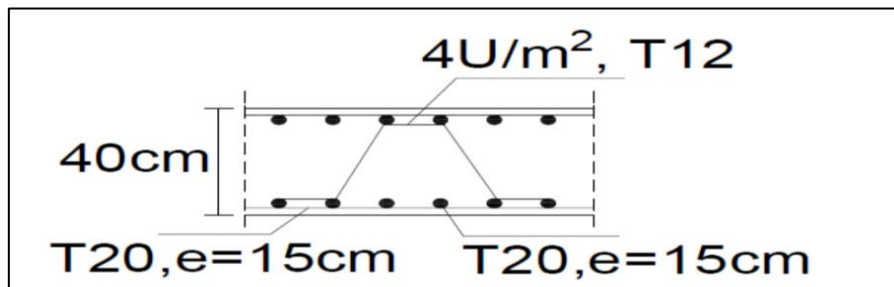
Ferrailage de la dalle du radier sur travée.
